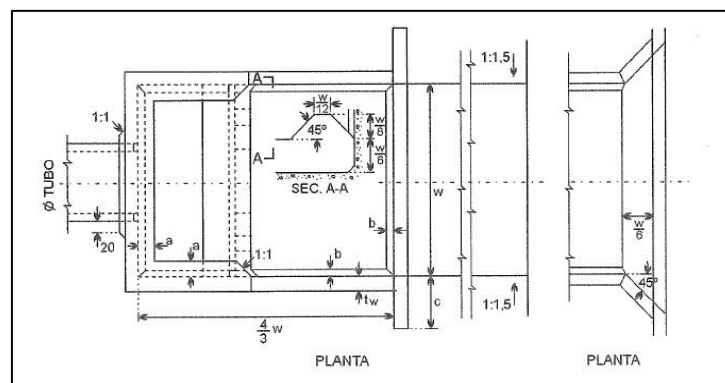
Dissipador bloco de impacto- Vista em planta.
